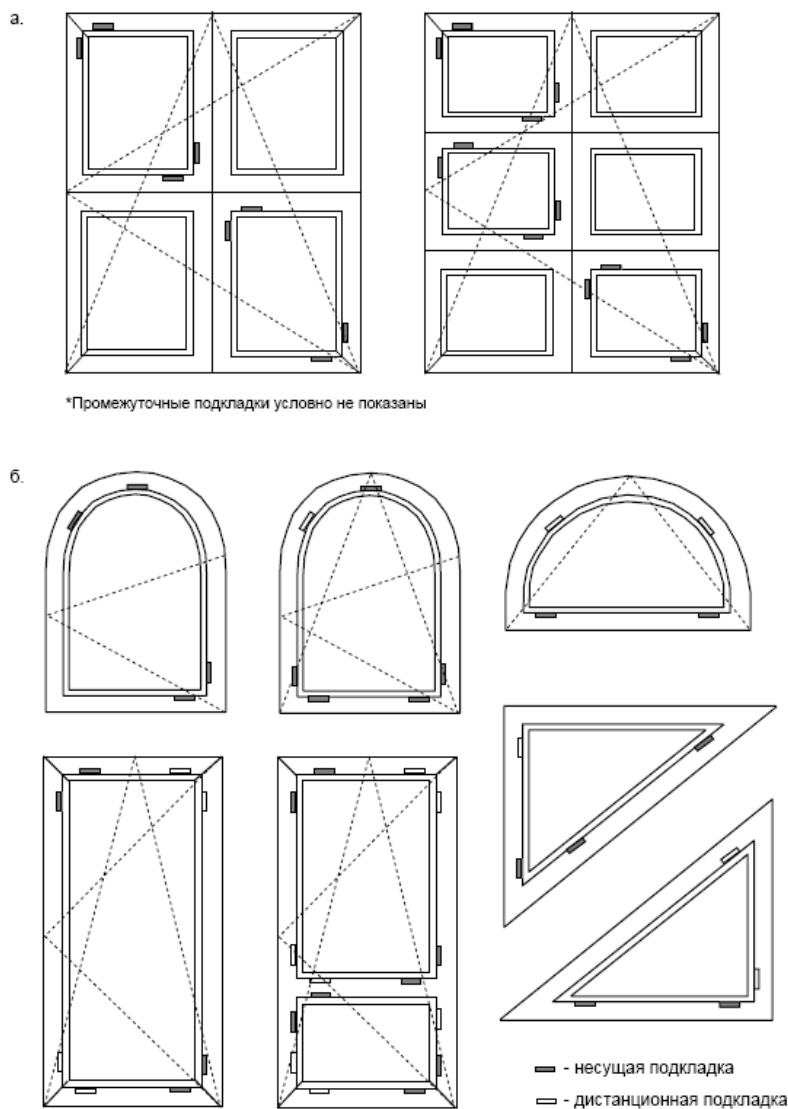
Примеры установки подкладок под стеклопакеты: а – в окнах с перекладинами (промежуточные подкладки условно не показаны); б – в окнах нестандартной формы
